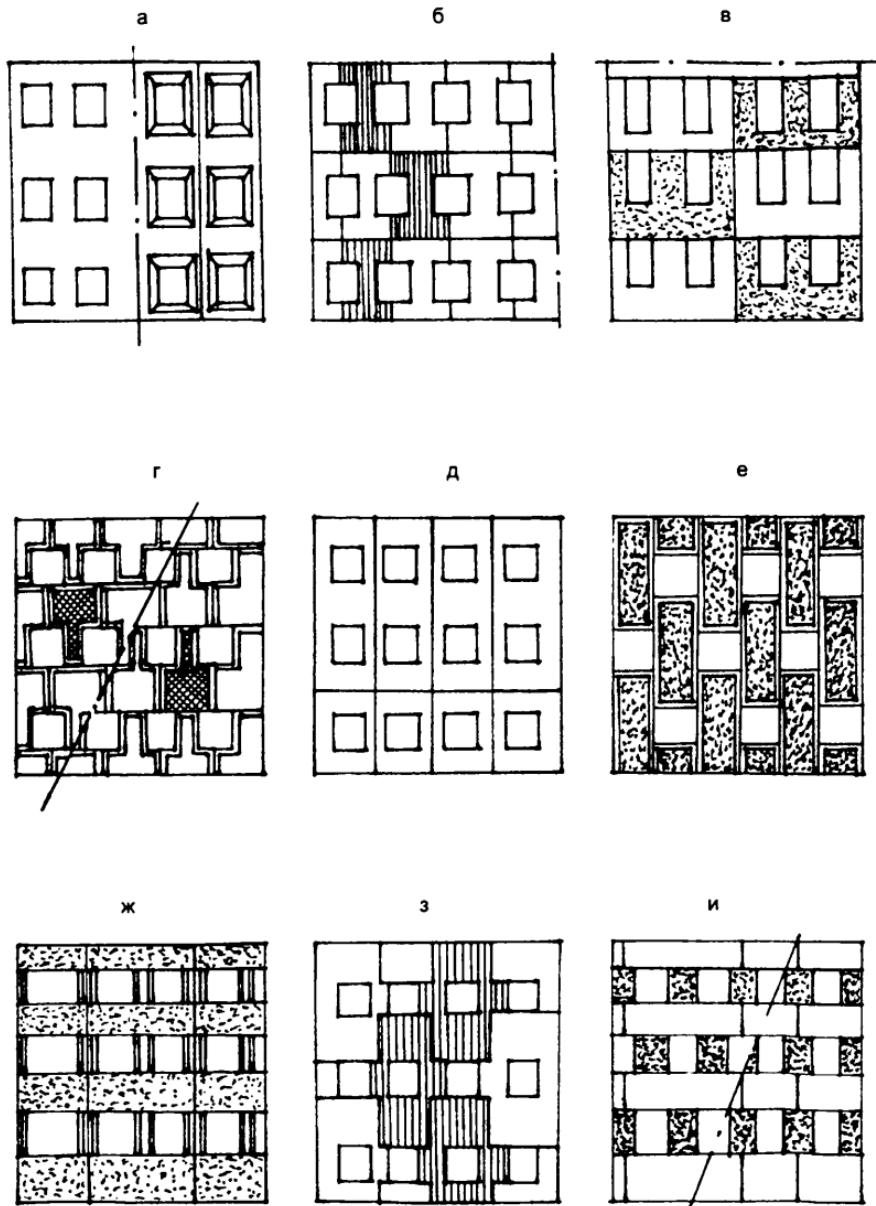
Схемы разрезки наружных стен панельных зданий:
